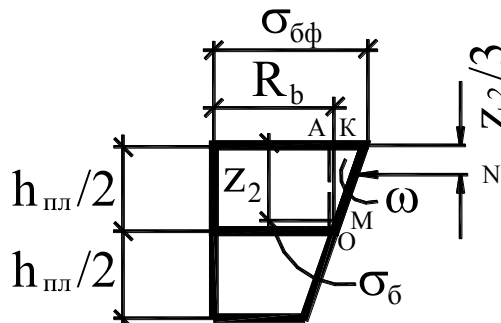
Схема к определению напряжений в железобетонной плите (2-й случай)
